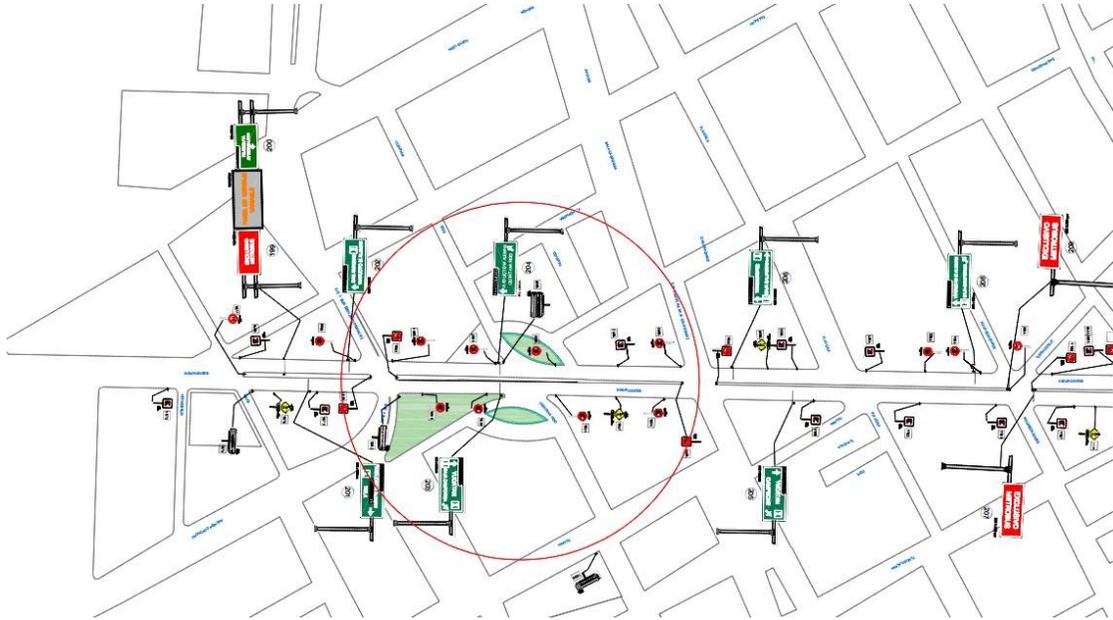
Plano Av. Insurgentes propuesta de instalación del señalamiento
